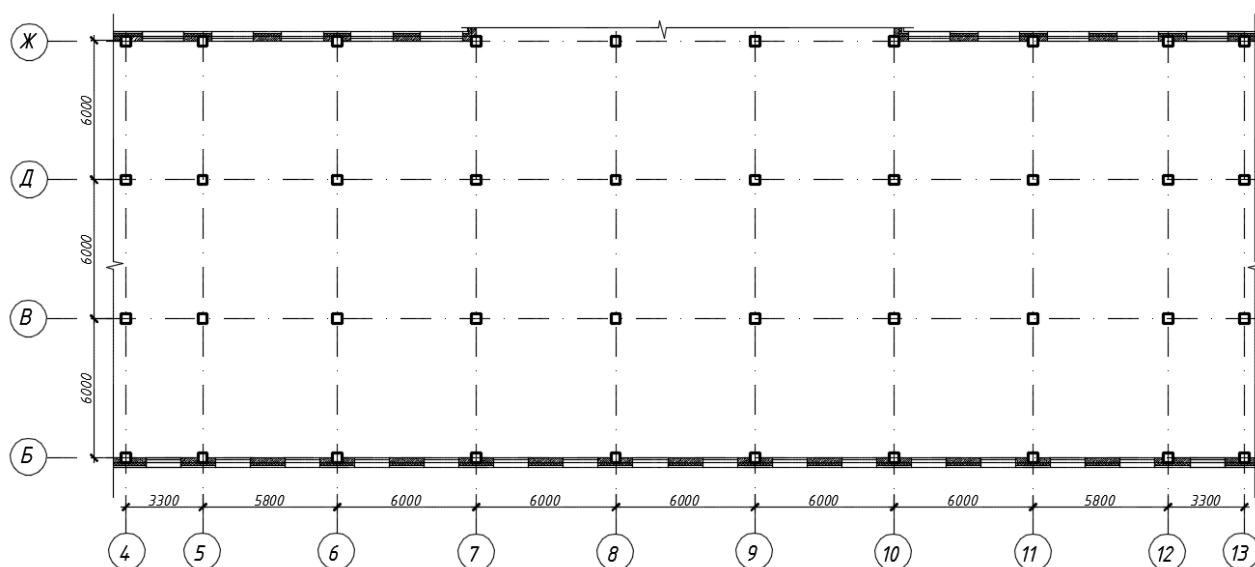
Схема перекрытия на отметке 0.000
